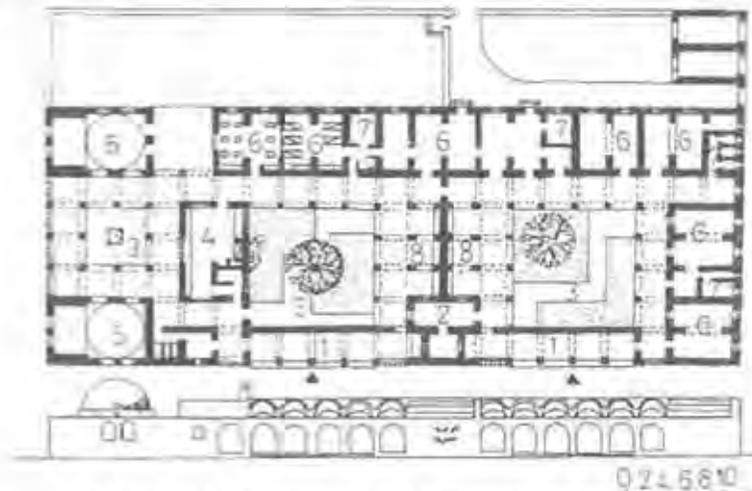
Grundriß und Eingangsfassade des Gesundheitszentrums
